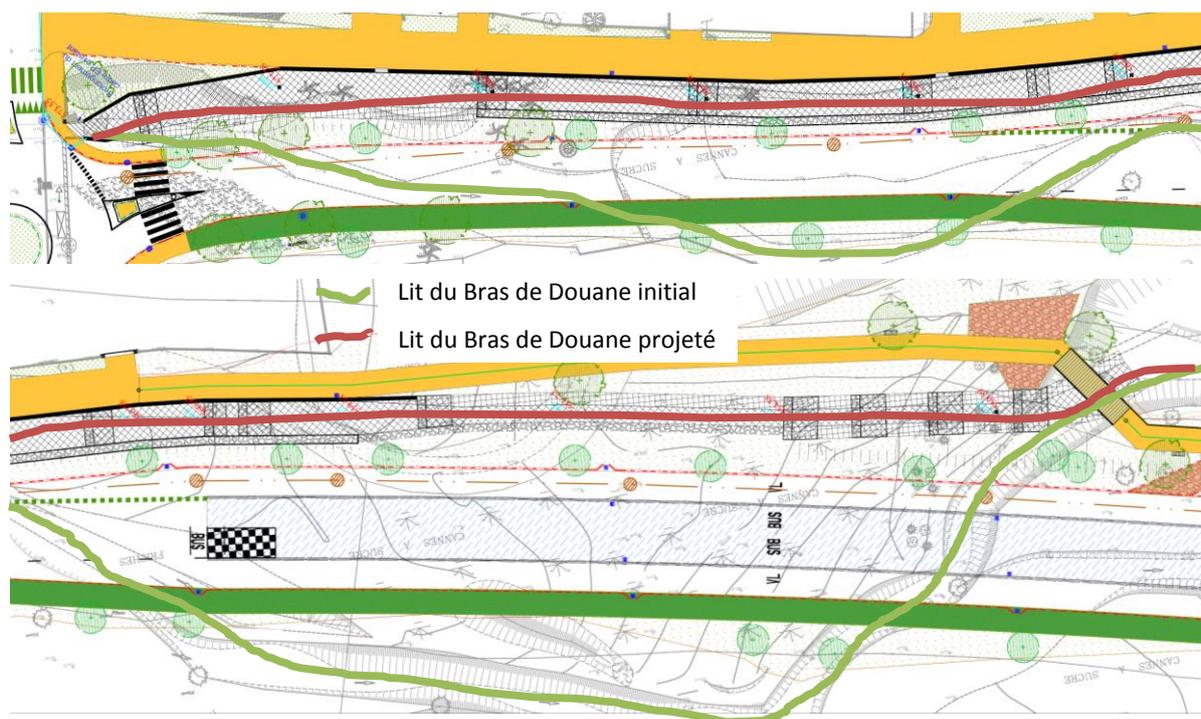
Détail du plan de masse du secteur de remblaiement de la ravine Bras de Douane de la RD3
